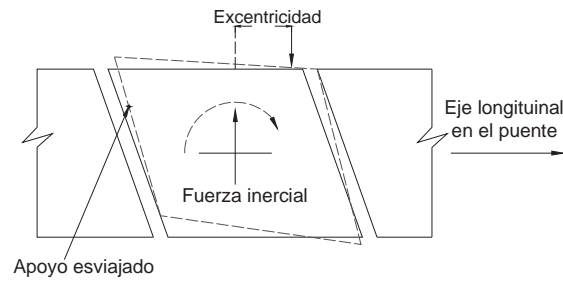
Falta de apoyo debida al esviaje del puente. (Adaptada de Priestley et al., 1996)
